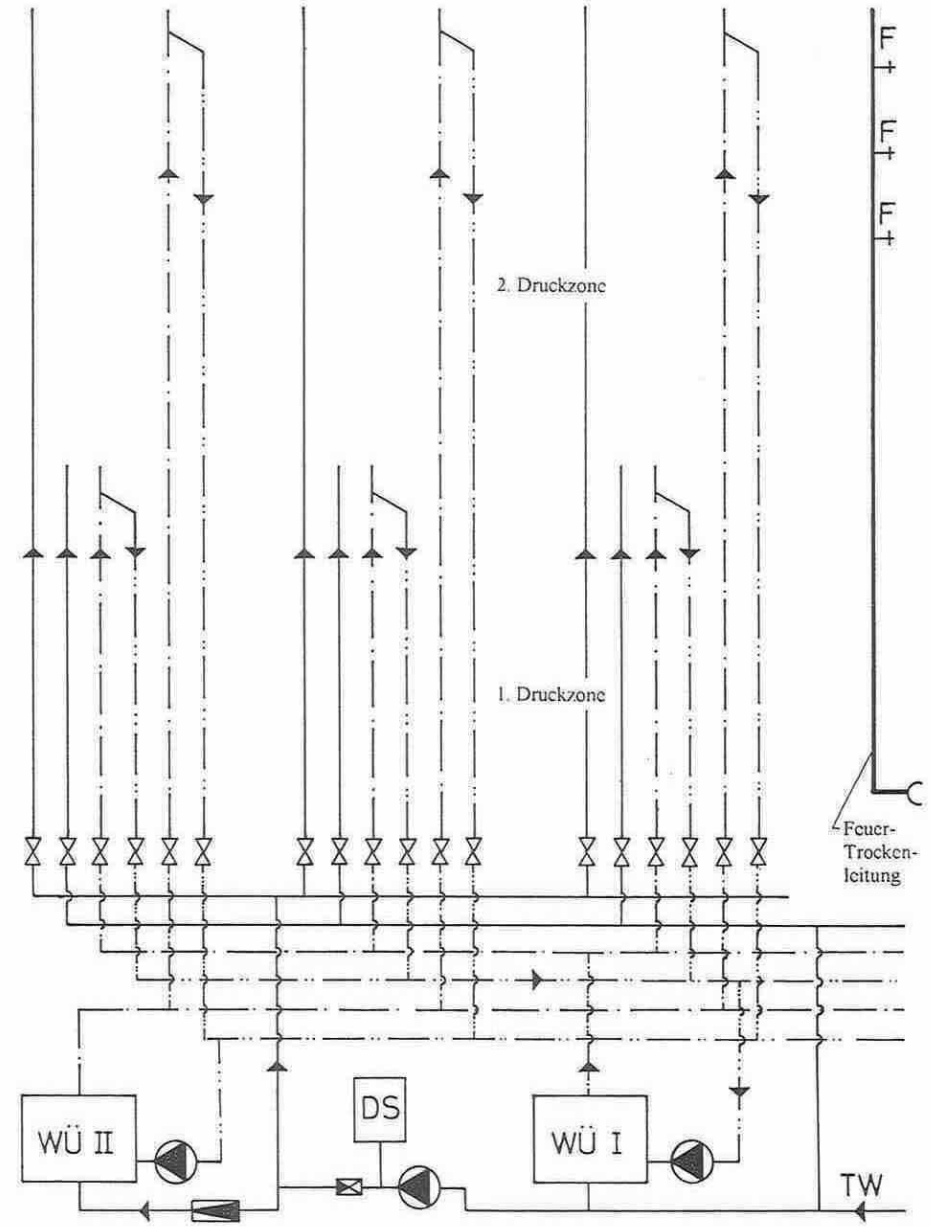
Schematische Darstellung der Trinkwasser-Versorgungsanlage mit zwei Druckzonen eines Wohnhochhauses, Variante II - Raum Leipzig - Dresden - Erfurt
